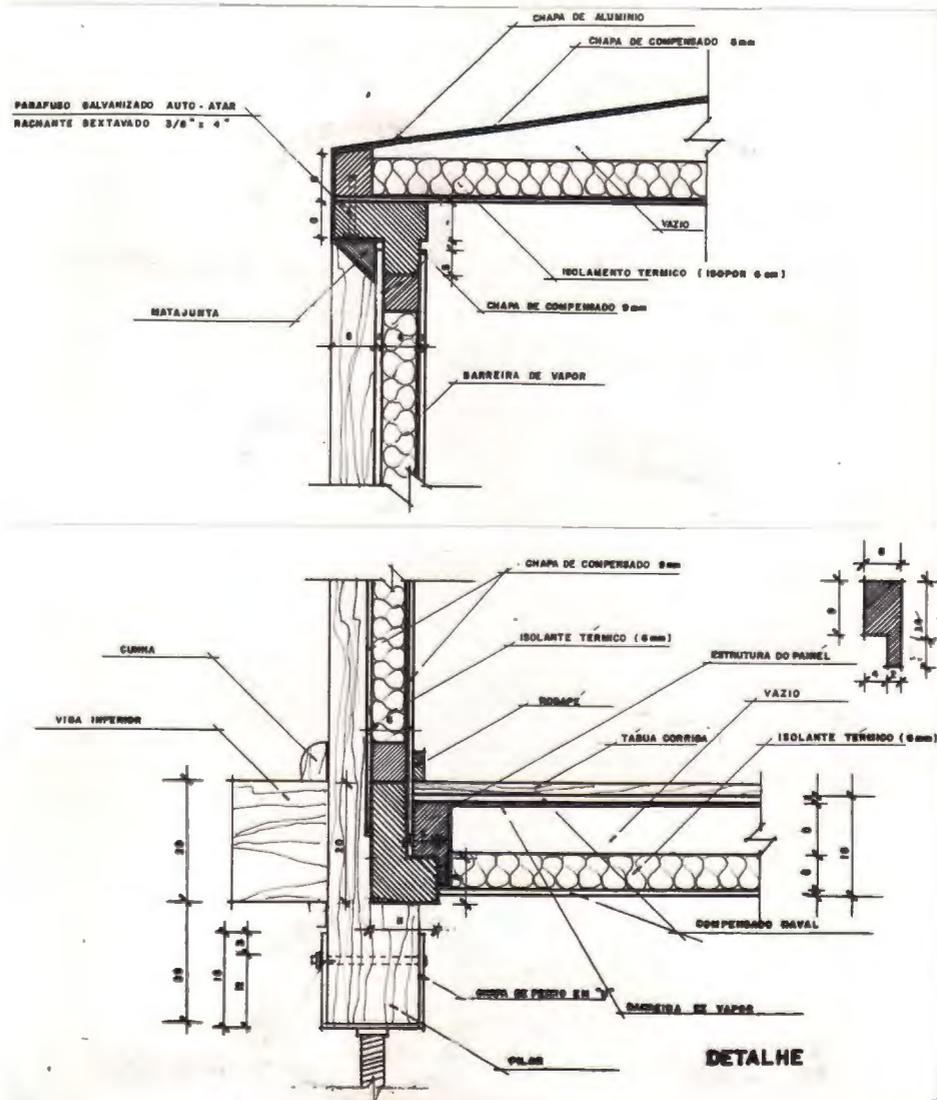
Detalhe do encaixe entre as vigas inferiores e superiores com o pilar, destacando-se a minimização no uso de elementos metálicos.
